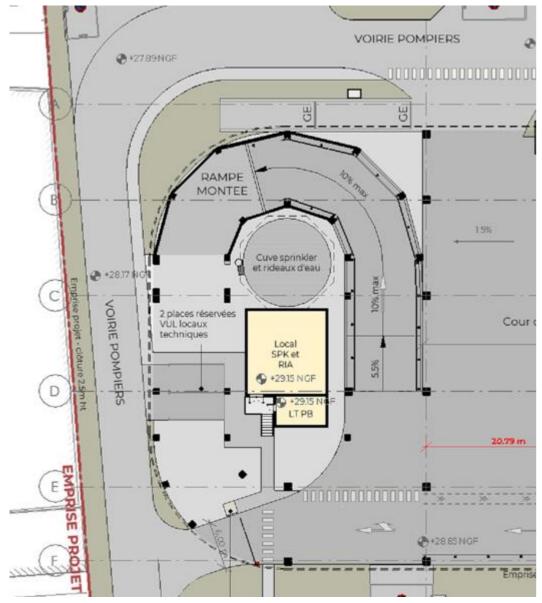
Extraits de plans de localisation des locaux techniques (Source : A26)
